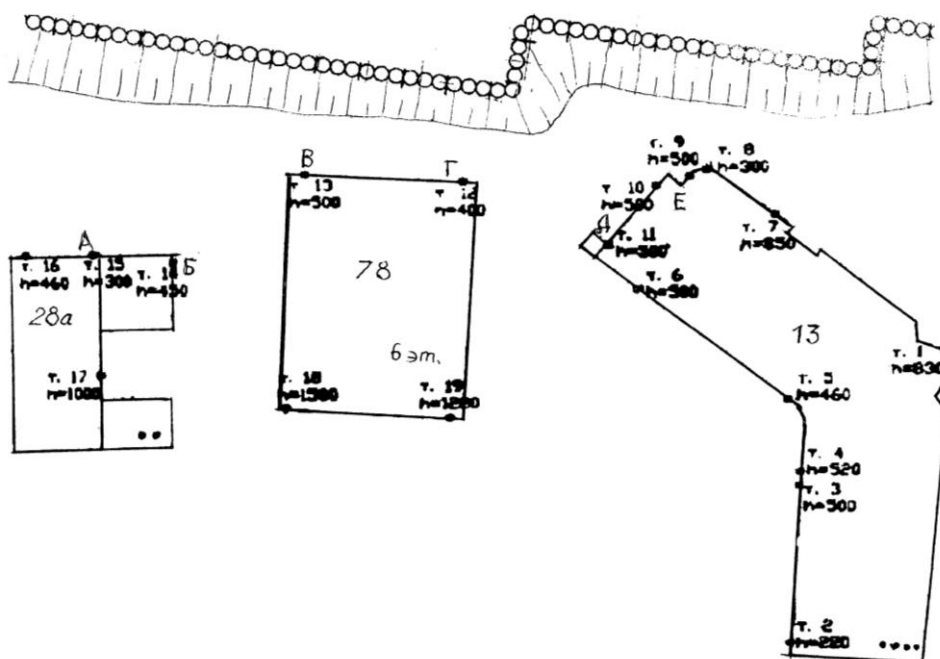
Относительное расположение стены ограждения котлована и зданий №28а, №78, 13 с местами установки осадочных марок №1...№19 и мини-призм DVR07с L-держателем на карнизной их части № А, Б (№28а), В, Г (№78), Д, Е (№13)
